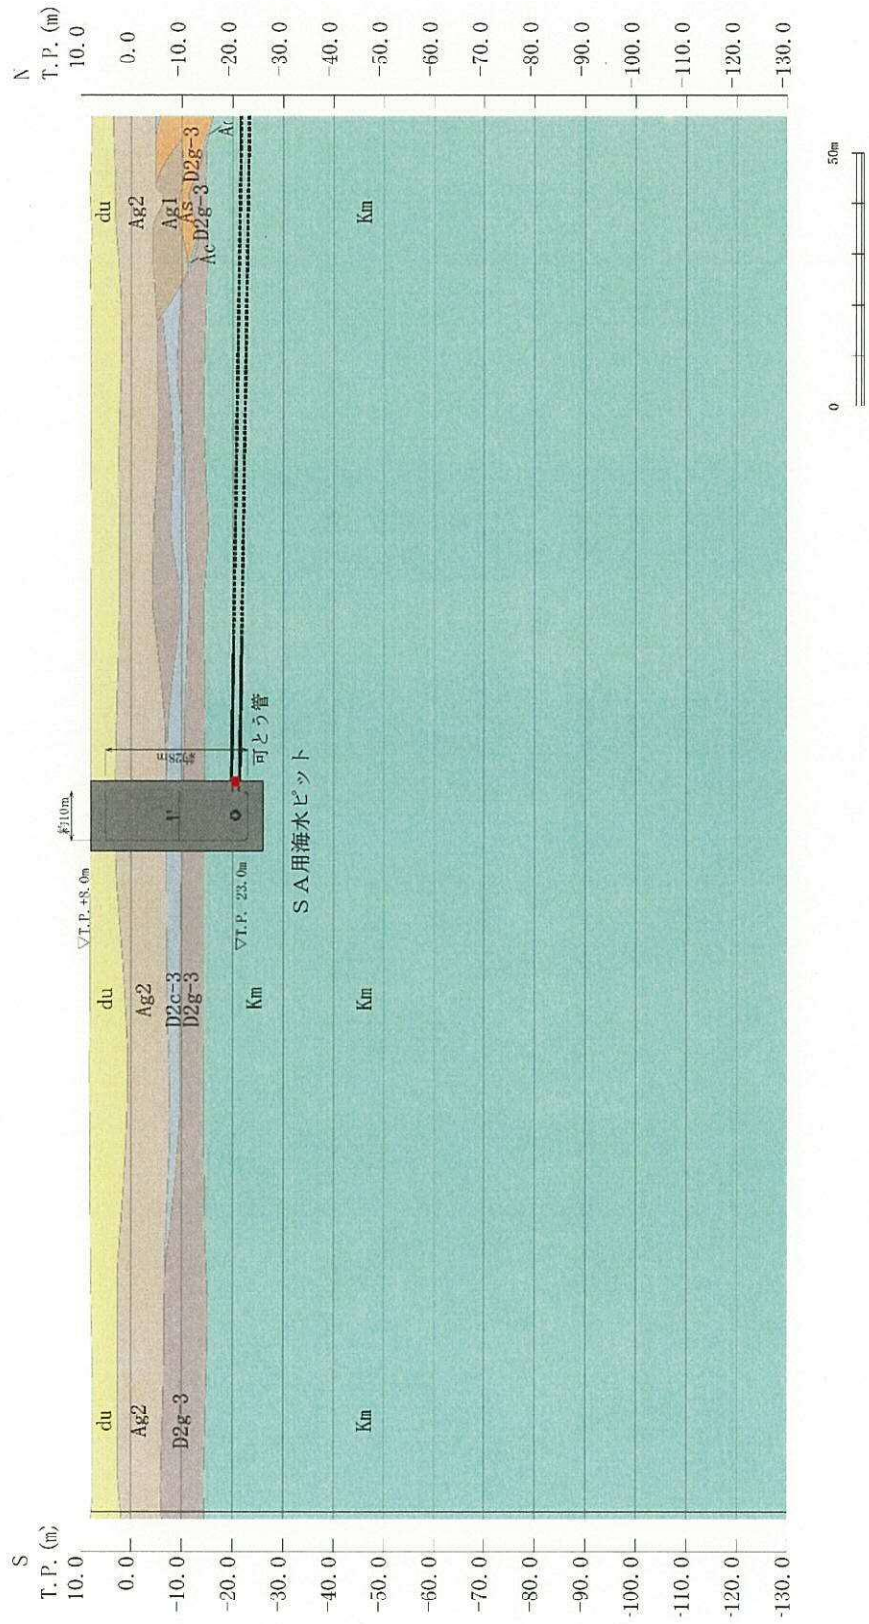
2-8 (2) SA用海水ビット 評価対象断面図 (②-②断面)
